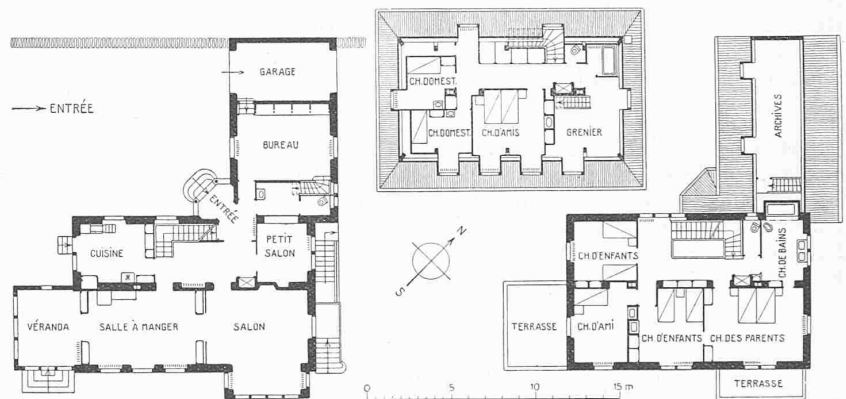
, 2 et 3. Plans de la Villa au Petit-Saconnex. — Echelle 1 : 400.
